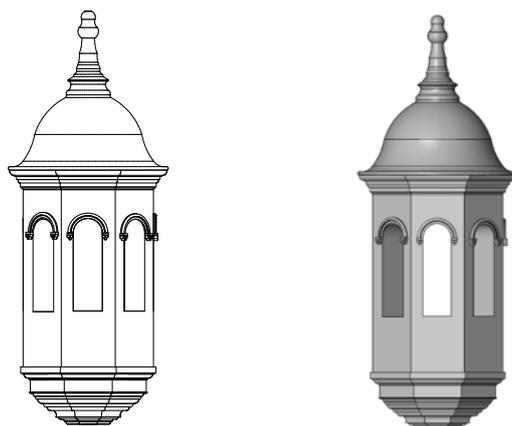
Familia constructiva: “balcón mirador”, elaboración propia.
